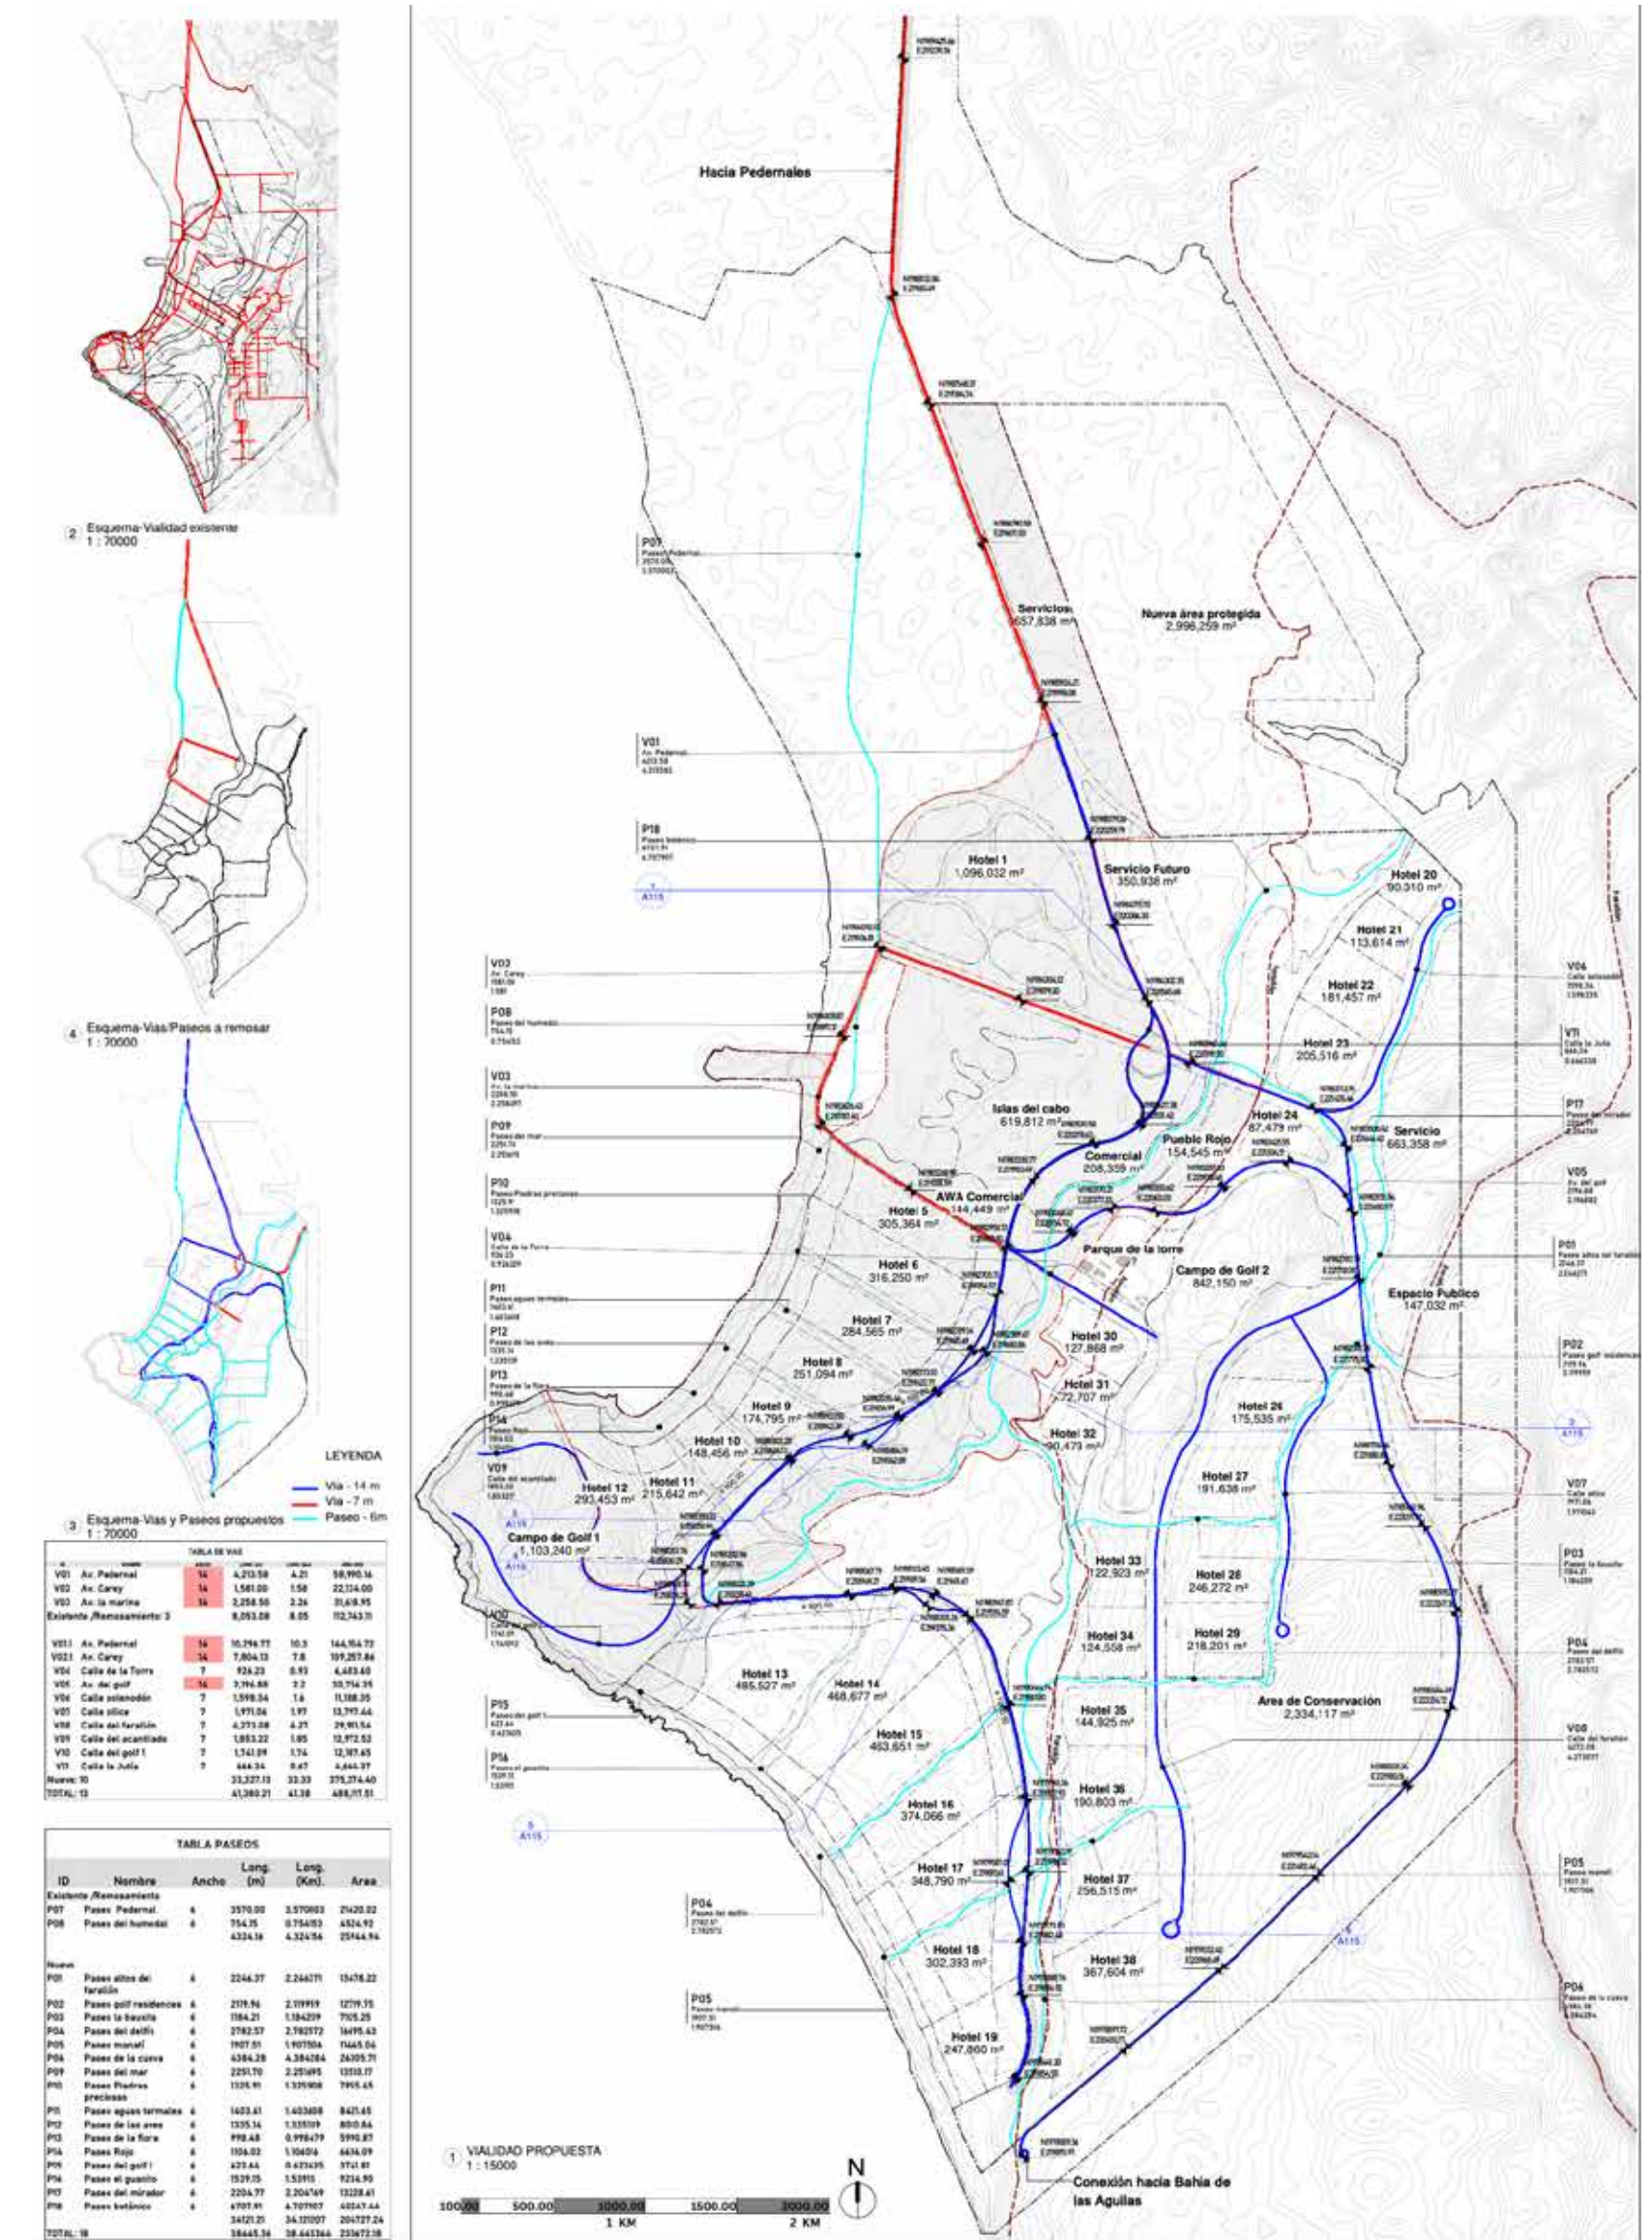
Vialidad existente. Plan Maestro Preliminar.
